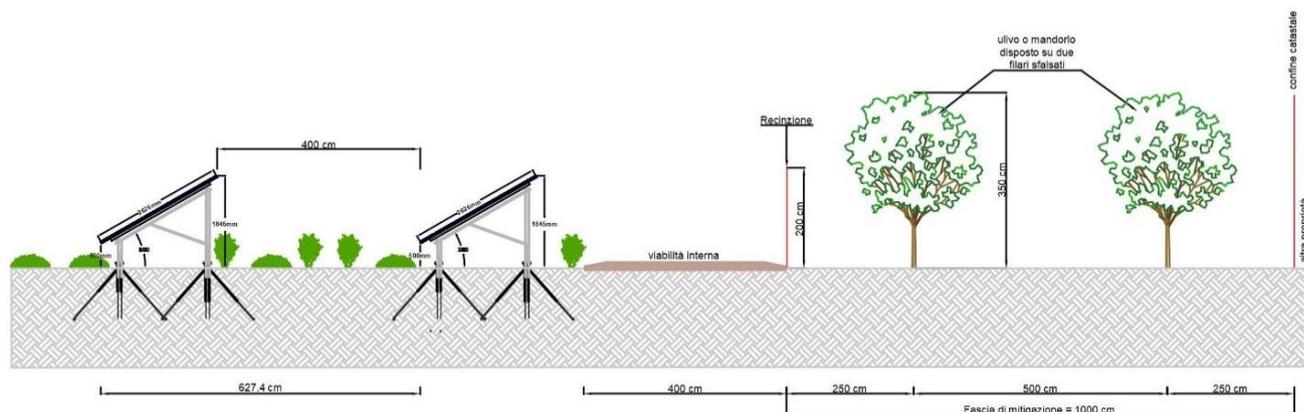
Area di mitigazione pianta e sezione trasversale e in pianta
